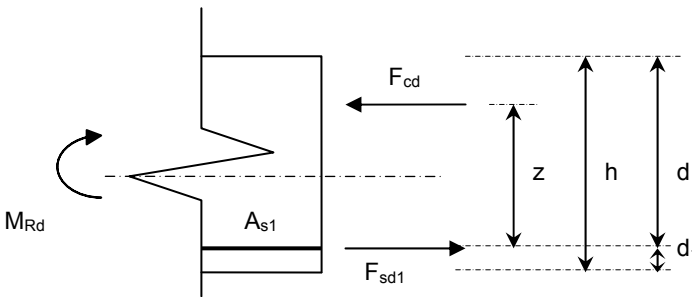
Einfach bewehrter Rechteckquerschnitt unter einachsiger Biegung
